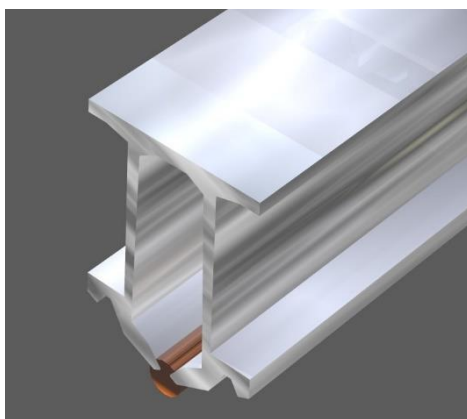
Profilo tipico di attrezzaggio LdC con sistema a catenaria rigida fissa
